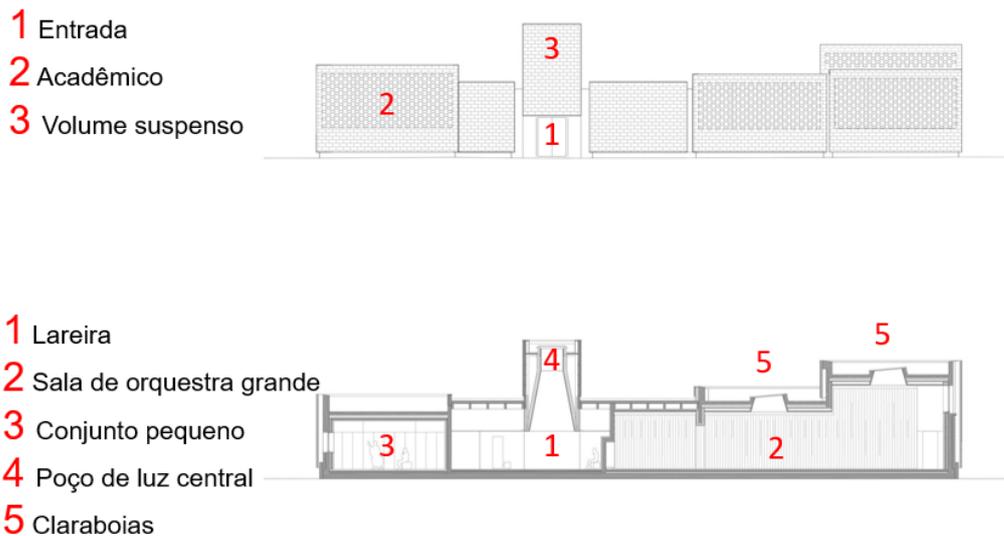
Corte esquemático e fachada frontal. Fonte: Adaptado de Archdaily, 2019.
